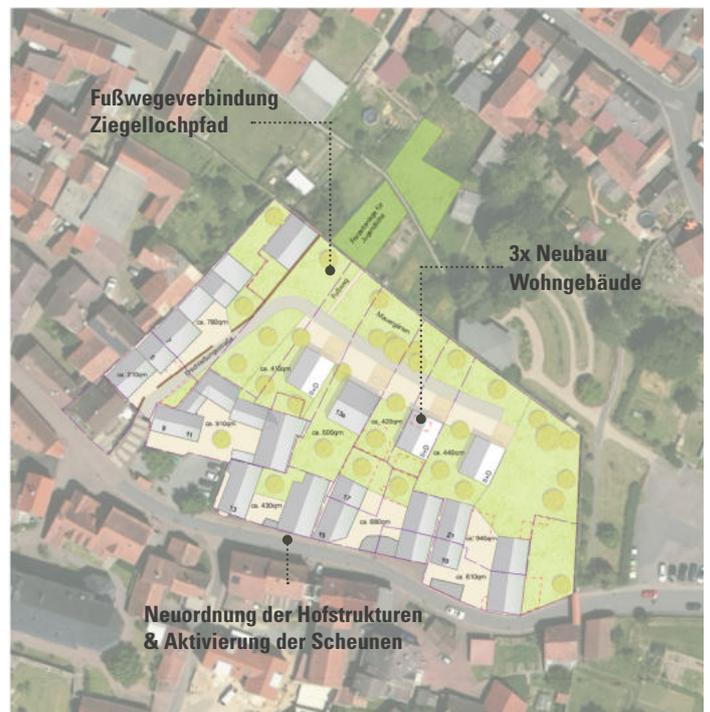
Lageplan - Neuordnung & Nachverdichtung Ölberg
